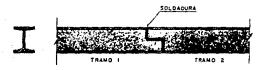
SOLDADURA DE UN PILOTE FORMADO POR UN PERFIL ESTRUCTURAL.
